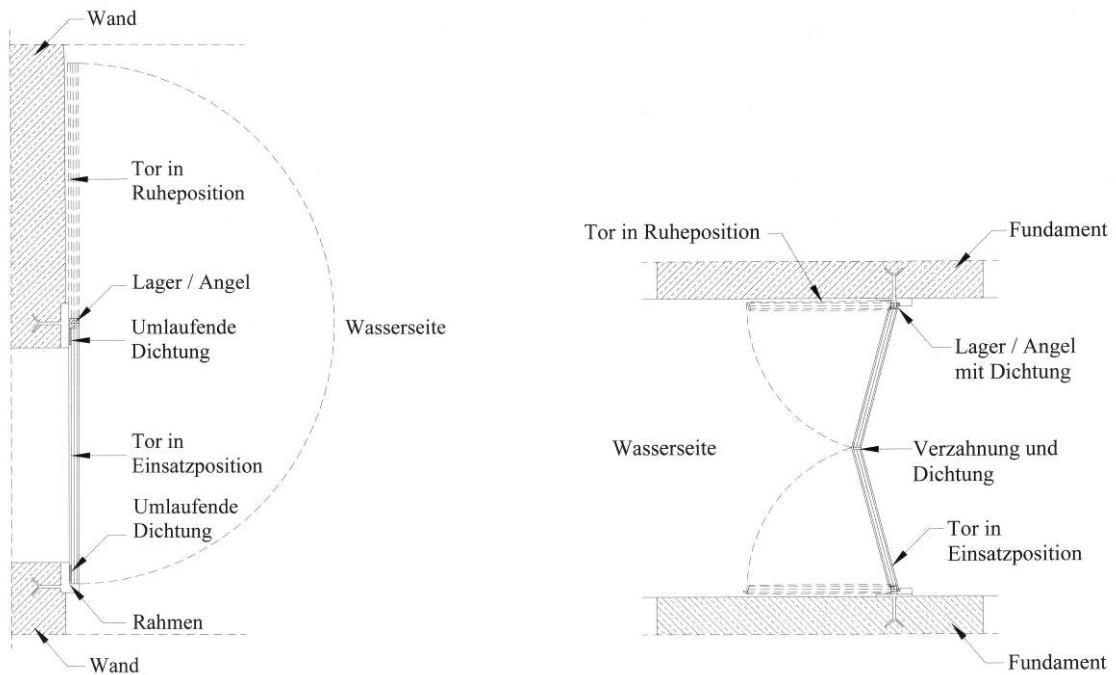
Draufsicht eines Schwenktors (links) und eines Stemmtors (rechts) [79]
